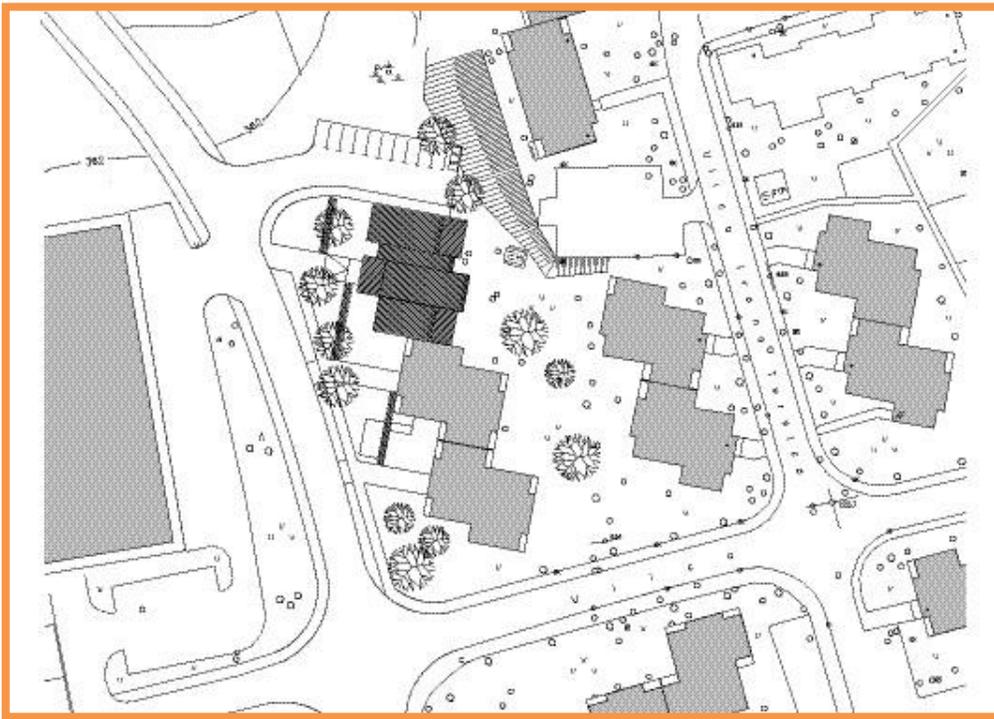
Planta de Conjunto (Paternoster, 2005) S/E
